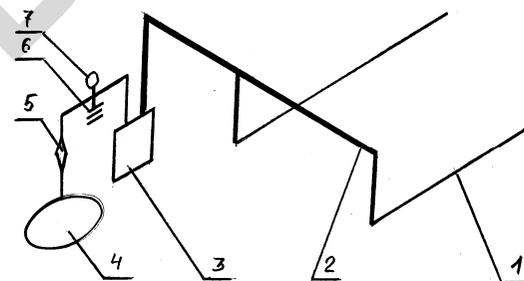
Торцовая схема монтажа магистрального трубопровода:
